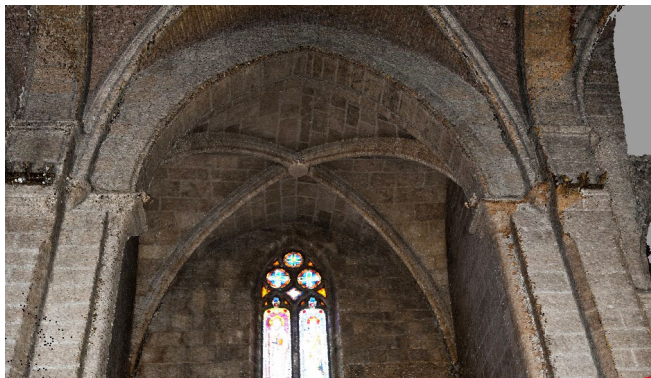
Vistas modelo 3D plementería realizadas con PhotoScan.
